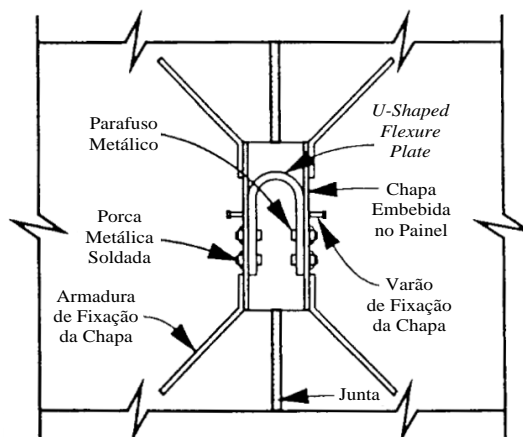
U-Shaped Flexure Plate*, adaptado de [29]
